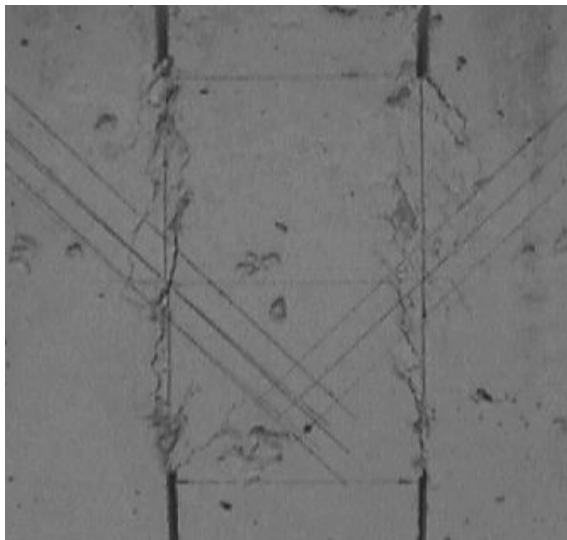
Esta foto presenta el lado "B" de la probeta Mon-Sano 02. El lado "A" también muestra la forma de fisuración esperada compuesta por una serie de pequeñas fisuras a 45° alineadas verticalmente.
